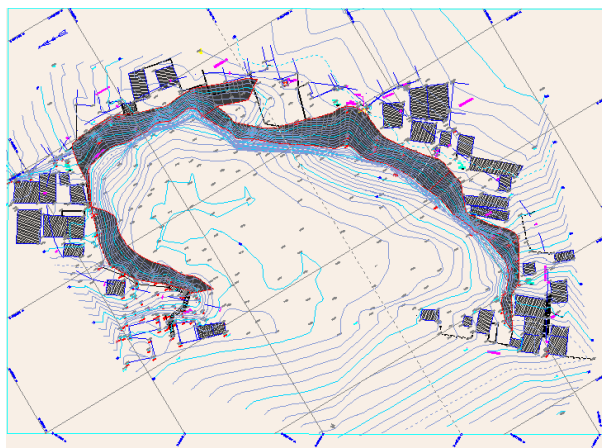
Planta baixa. Fonte: Adaptado de Projeto Executivo PDE 013 (2014).
